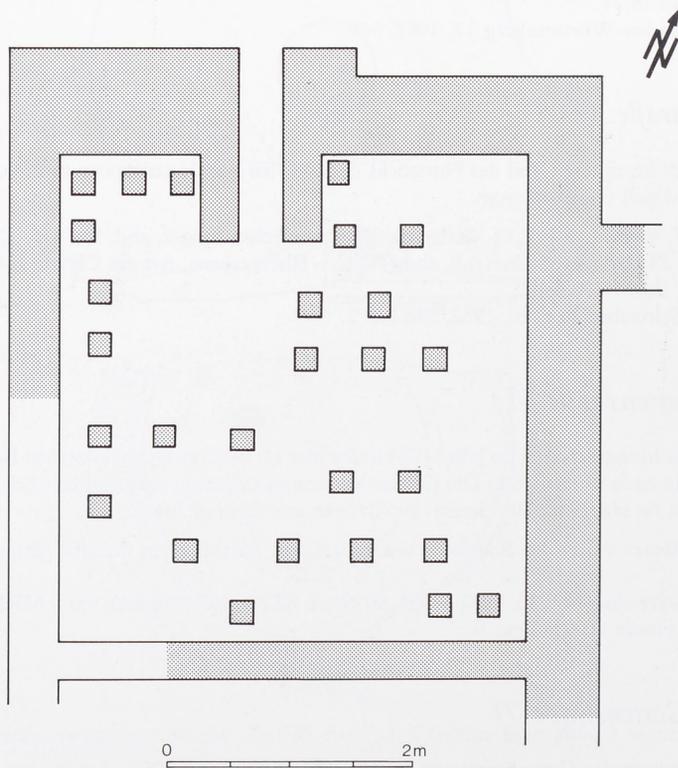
Fdst. 24: Gartenstraße 67. Steingebäude mit Hypokaust.
